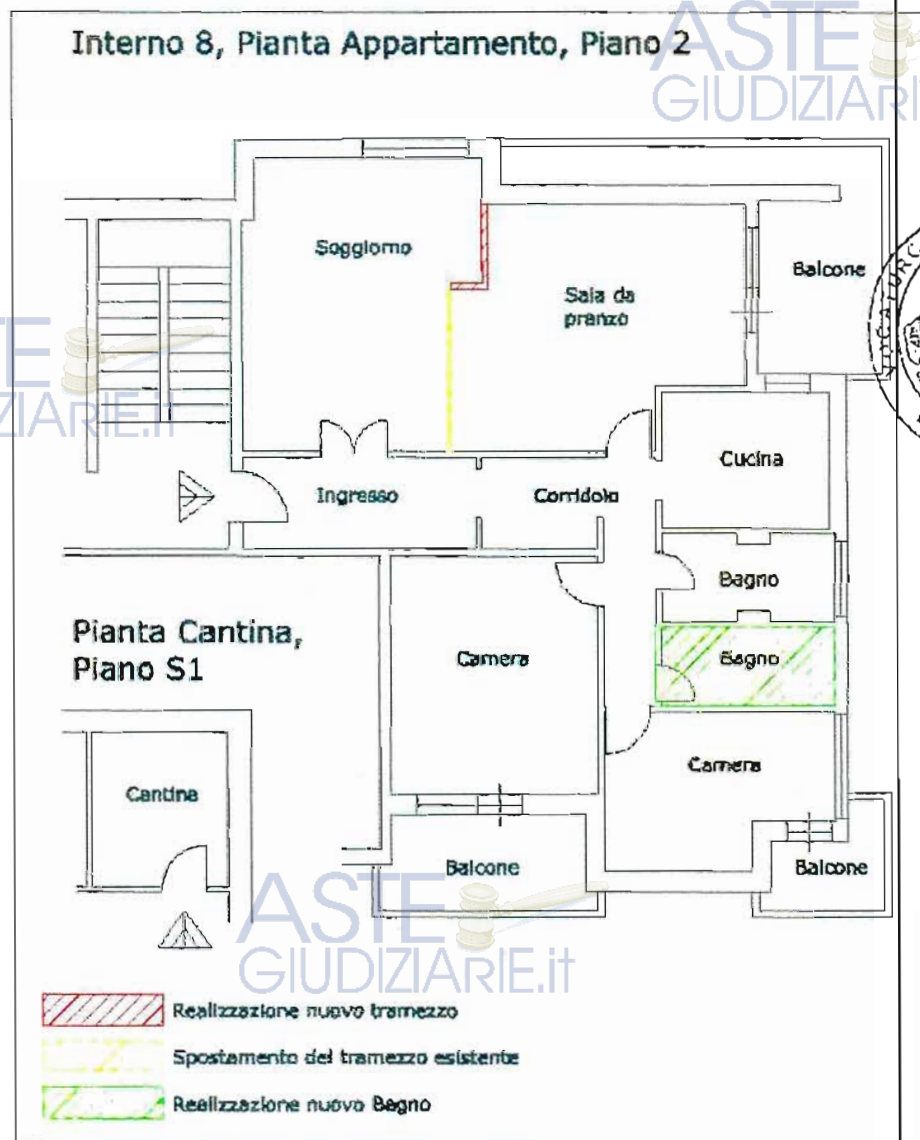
Planimetria da rilievo con aree di difformità rispetto al catastale
